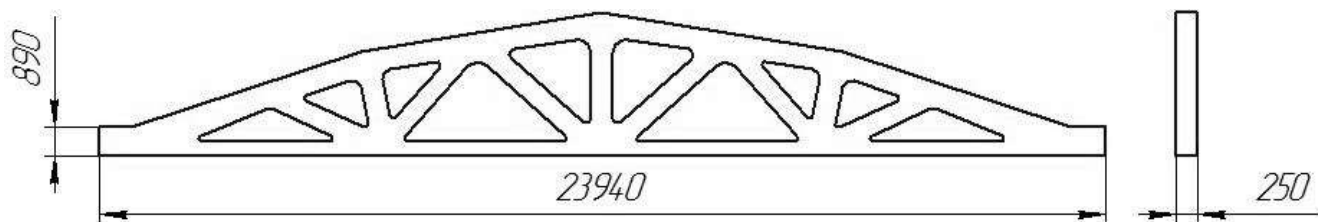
Габаритные размеры железобетонных ферм
